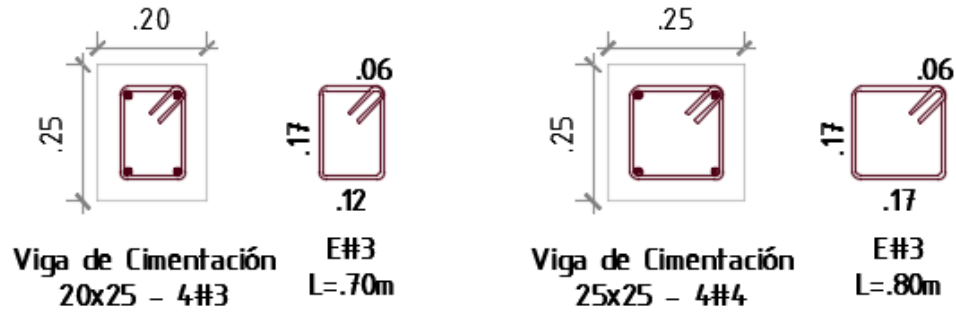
Detalle de refuerzo de vigas de cimentación (a nivel de terreno)
